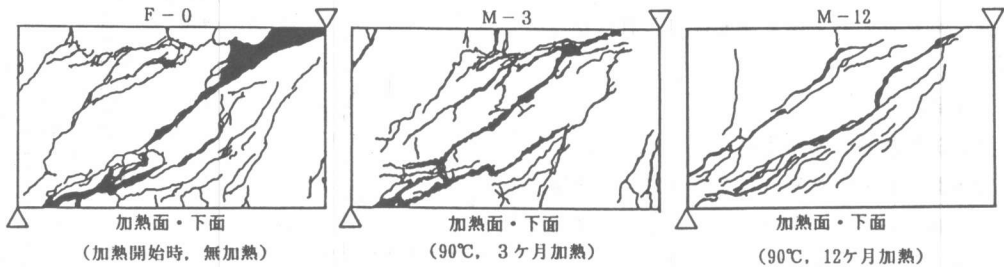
最終ひび割れ状況 (無加熱, 90°C加熱)
